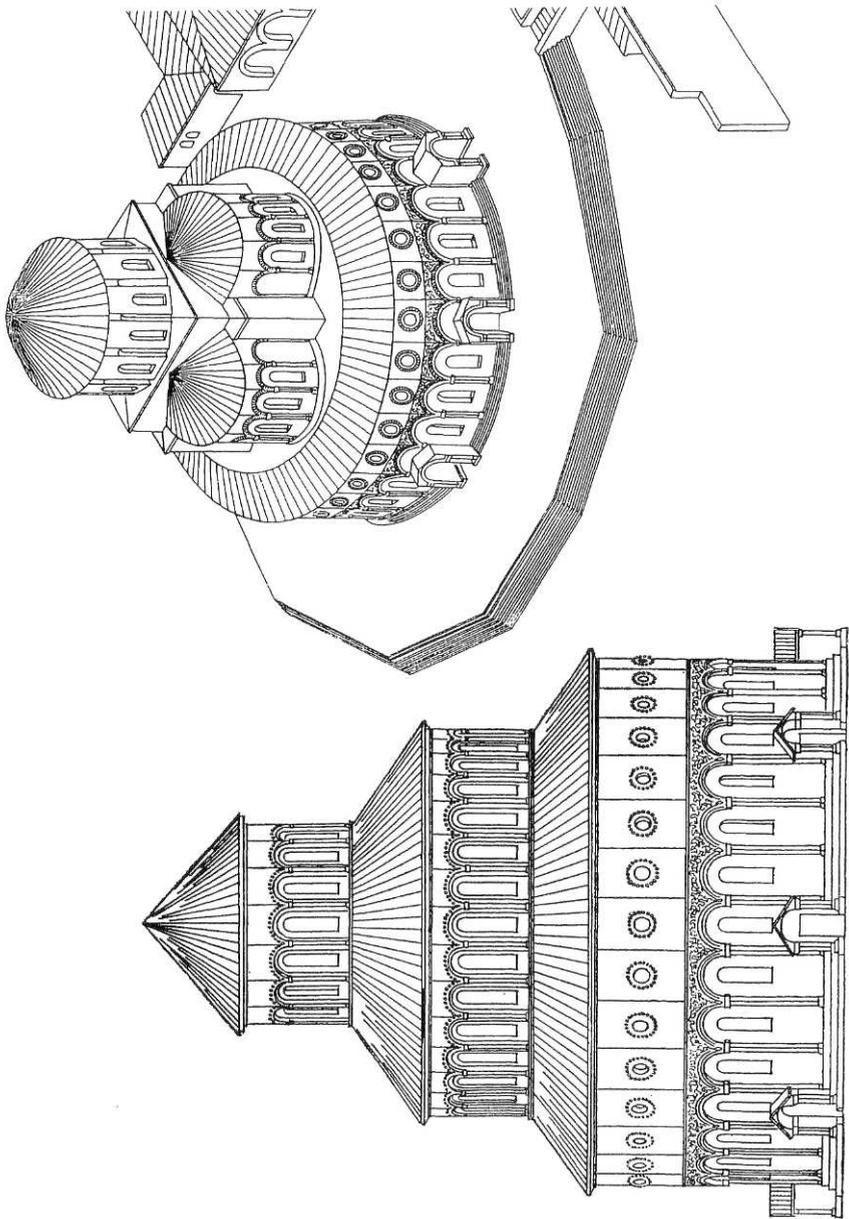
, 8b: Swartnoz: 2 Rekonstruktionen der zerstörten Kirche, Grundriss s. Abb. 1
